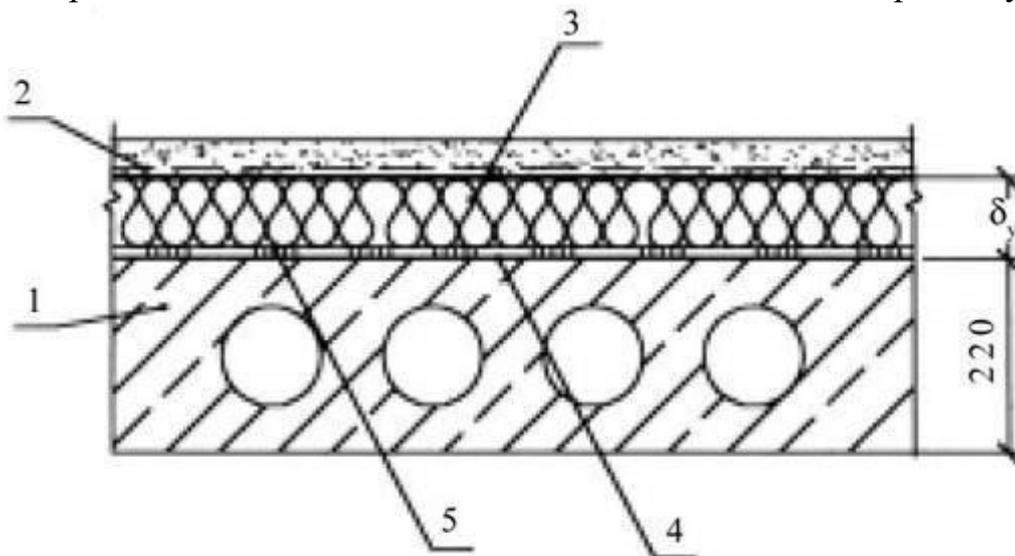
Утеплення перекриття холодного горища жорсткими теплоізоляційними плитами з влаштуванням армованої стяжки: 1 – перекриття; 2 – армована бетонна або цементно-піщана стяжка; 3 – плити теплоізоляційні жорсткі; 4 – пароізоляція; 5 – приклеювання плит утеплювача.
